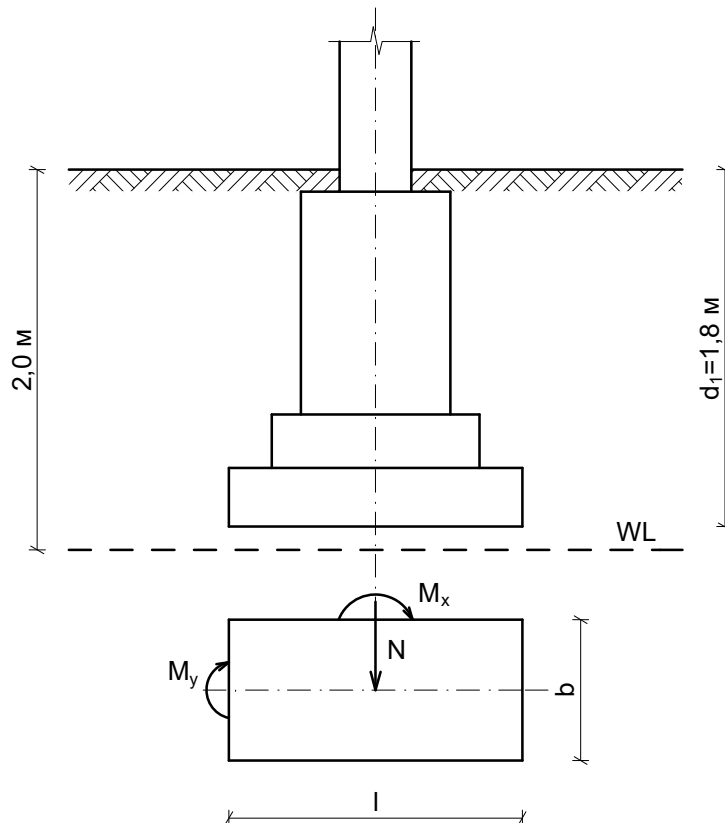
Схема розташування фундаменту в ґрунті і навантажень на фундамент
